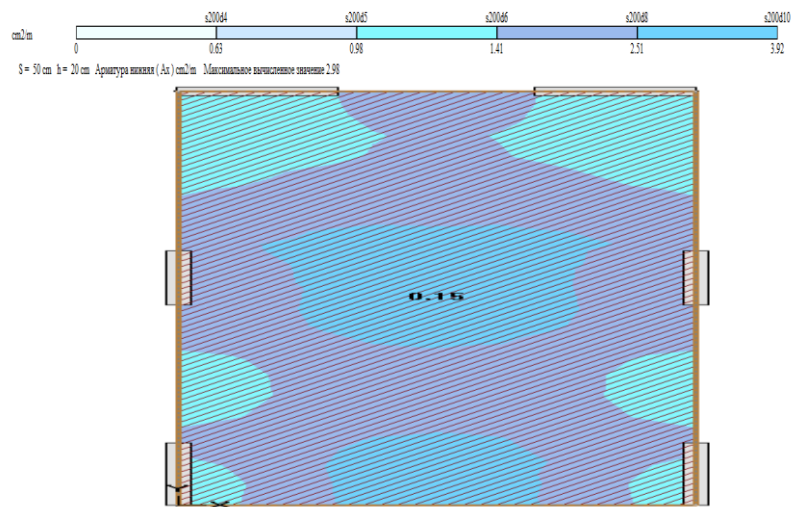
Схема ізопалей та ізоліній арматури нижніх сіток плити вздовж осі X
